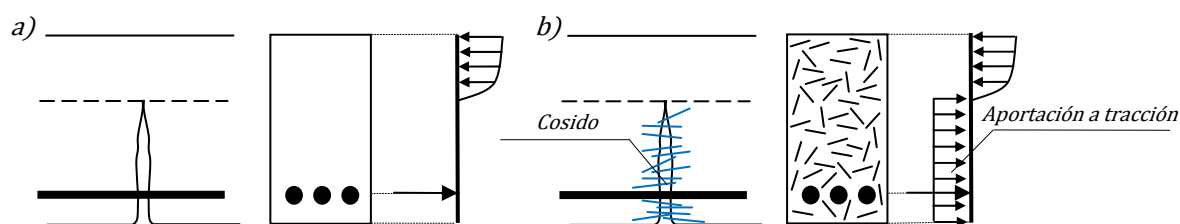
Distribución de tensiones para una sección: a) de HA y b) HRF con armadura. [5].
